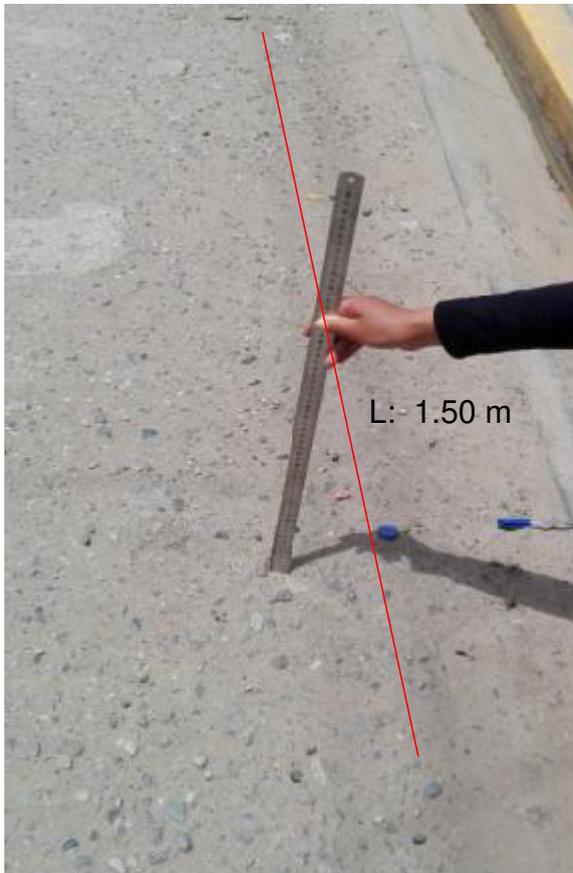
Medición de baches en el pavimento flexible de la avenida San Carlos, ubicado entre el pasaje Santa Rosa y Jr. San Antonio – Fecha: 06 de febrero de 2018.
